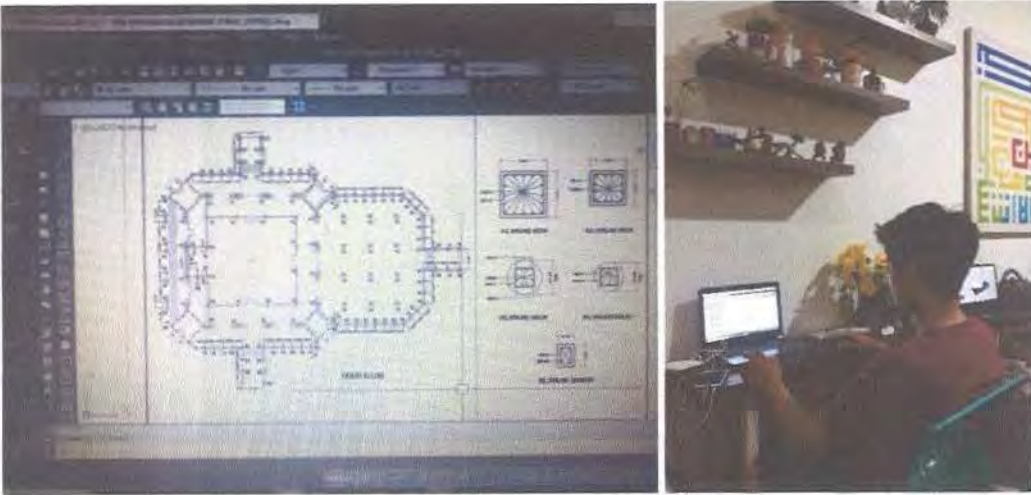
Pengerjaan Detail Pondasi Masjid
